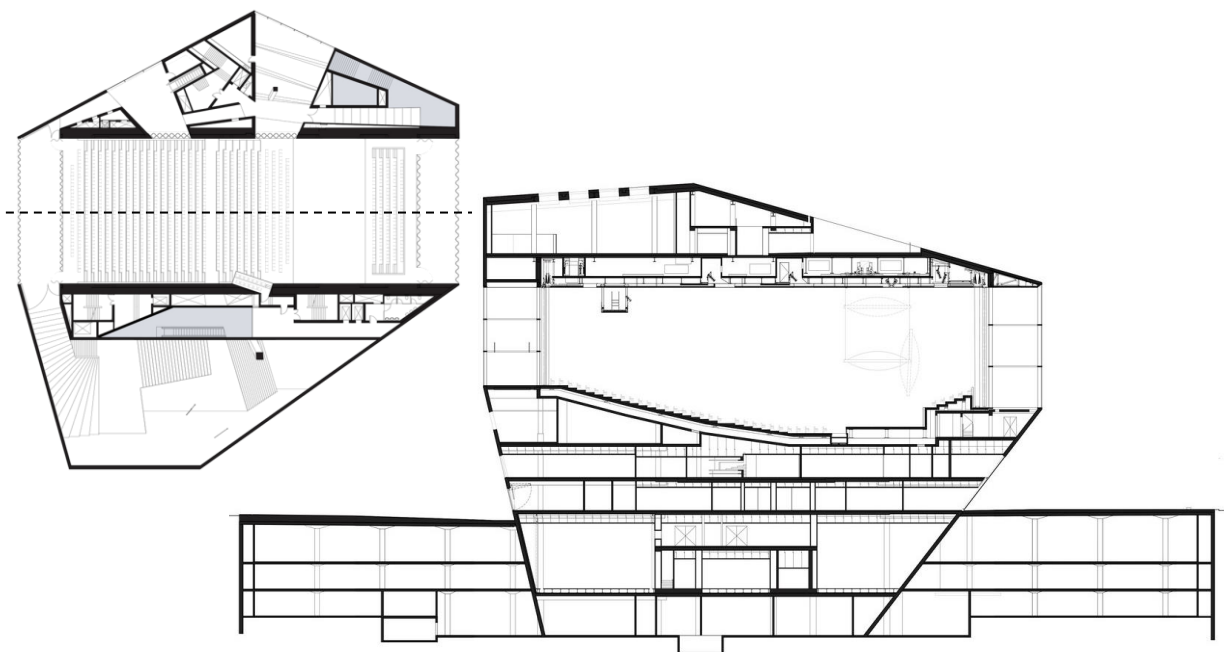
Planta Baixa e Corte da Sala de Concerto
